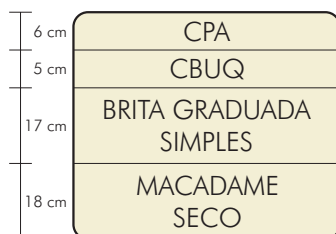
Perfil do Pavimento da BR-282/SC Trecho entre Lages e São José do Cerrito.
